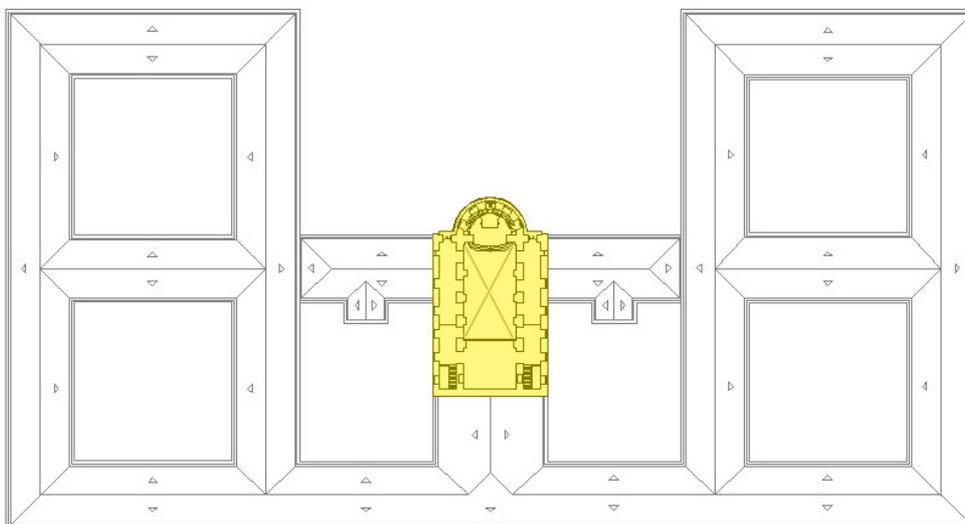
Planta do 3º pavimento, Palácio Universitário.
